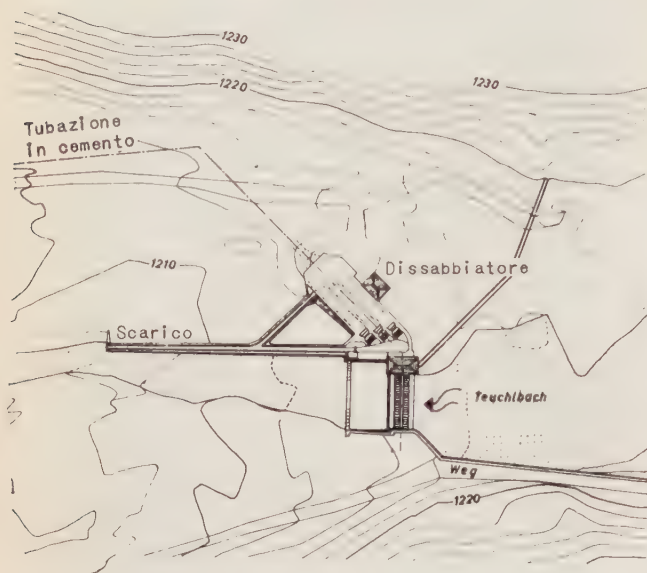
Planimetria della derivazione dal Teuchlbach.
